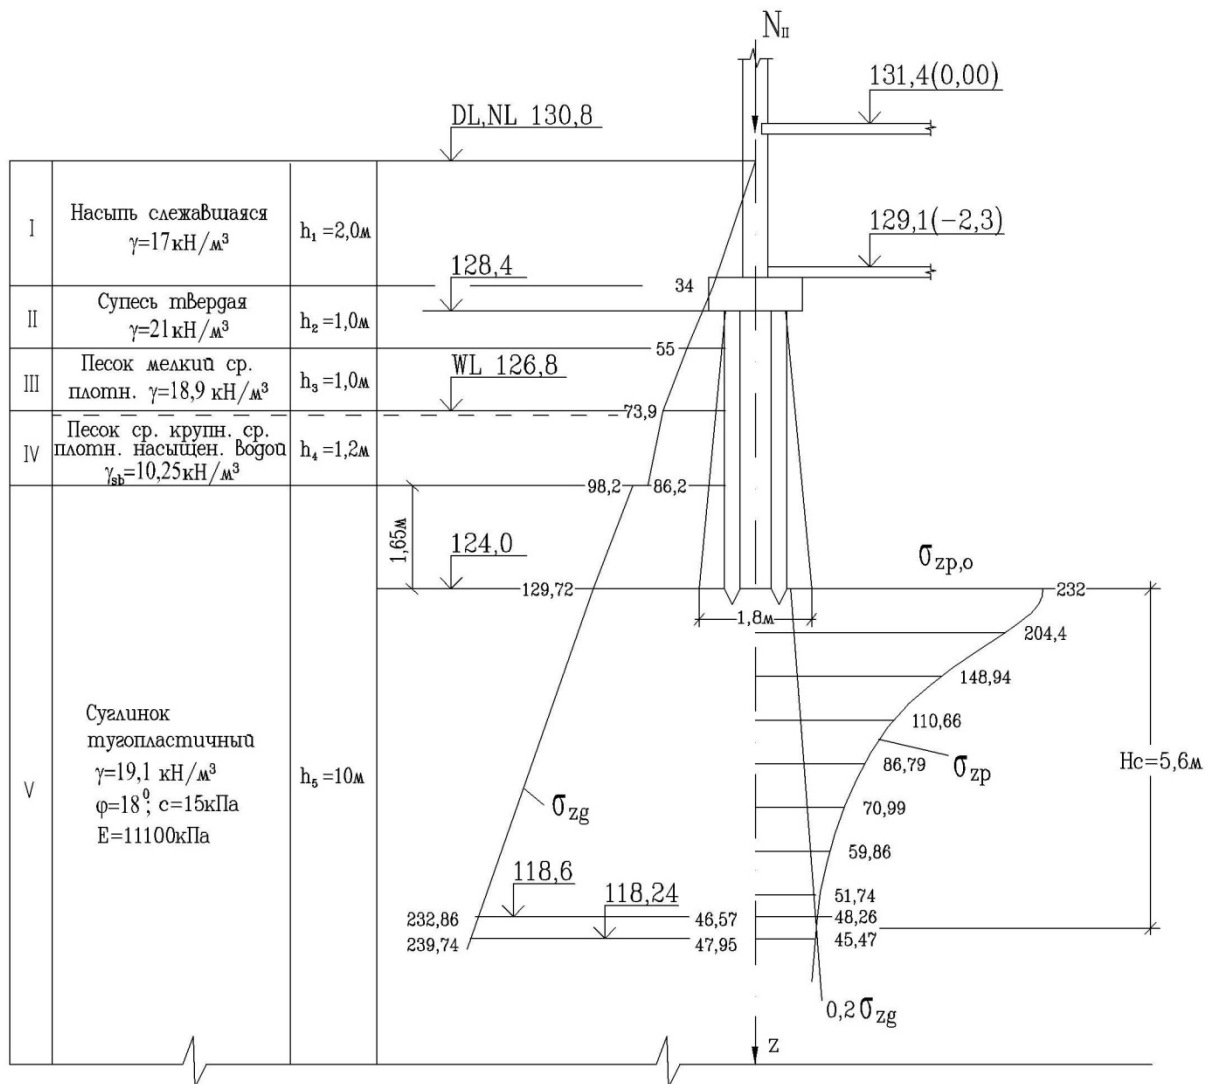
Расчетная схема для определения осадки свайного фундамента методом послойного суммирования
